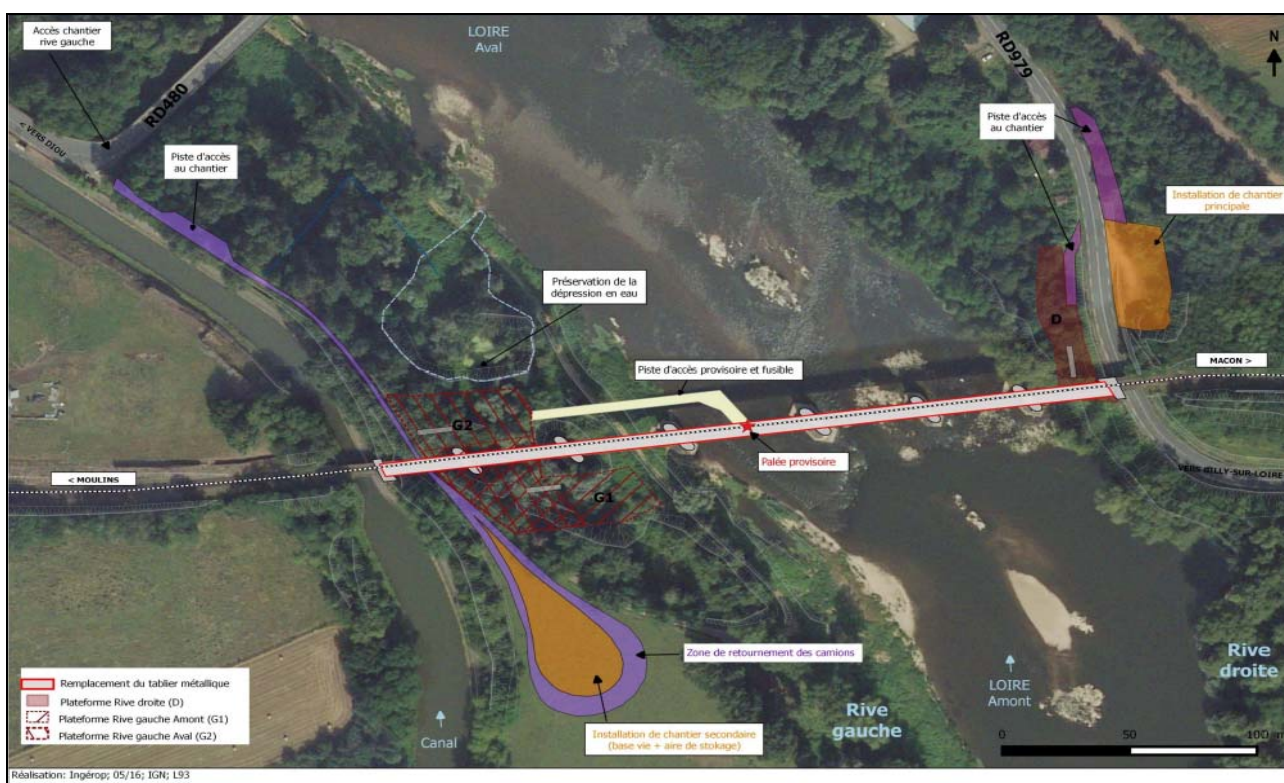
installations de chantier et ouvrages d'accès. (Source : dossier)
